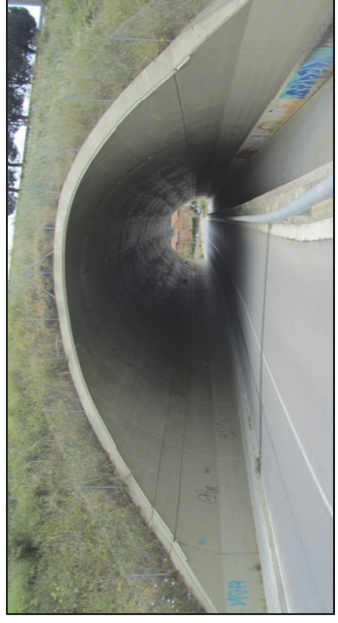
Estructura F03, culvert de l'autopista C-32 sobre el rial de Can Figuerola.
